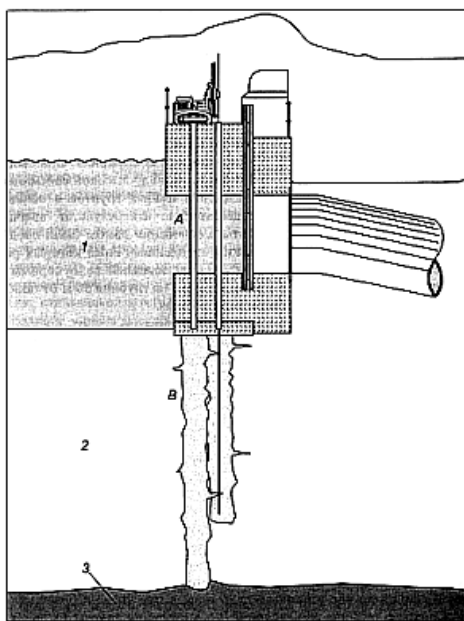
Противофильтрационная завеса (для противосейсмической защиты) из пересекающихся грунтобетонных колонн
